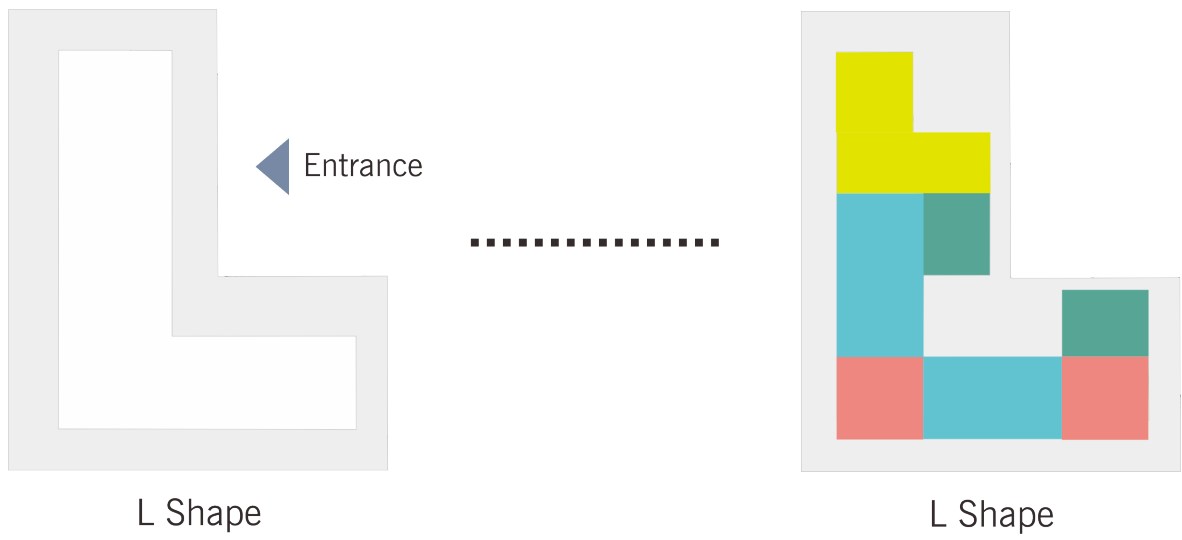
Alternatif zonasi 2 pada site L shape
